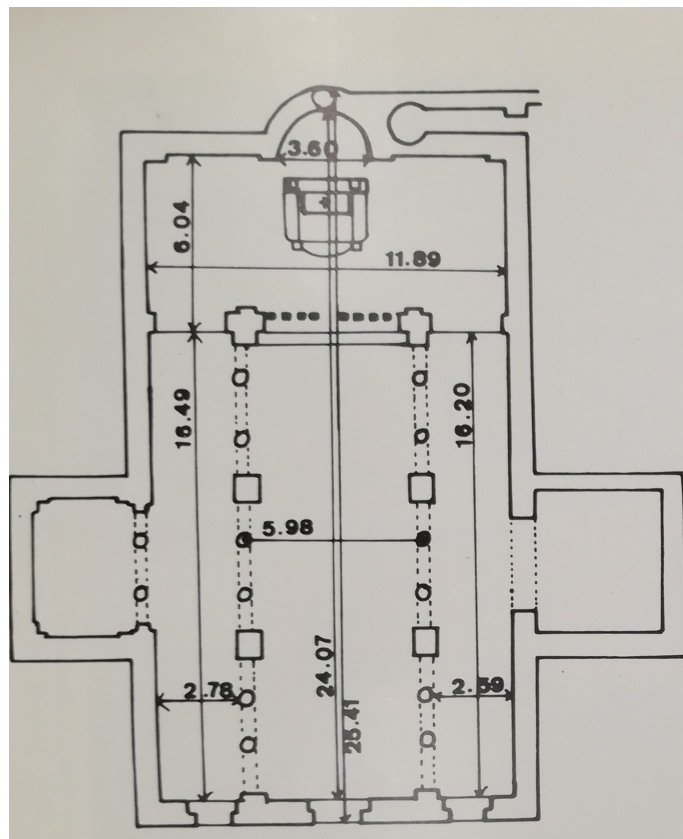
Ricostruzione della pianta di Santa Maria in Portico.
